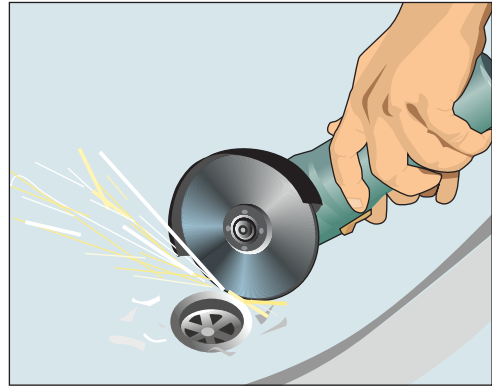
Выпиливаем сливное отверстие с помощью ножовки или болгарки
